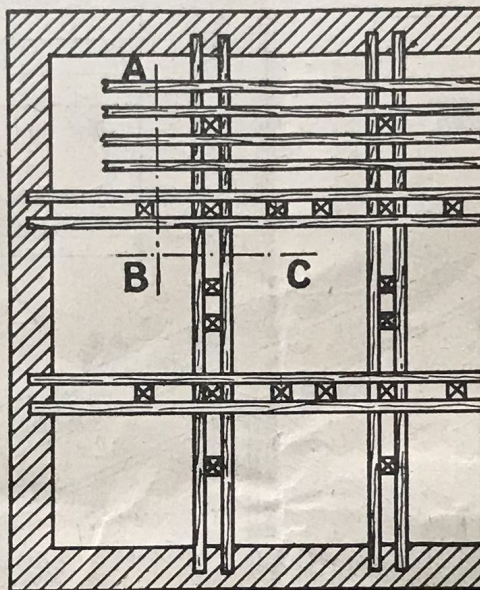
Vue en plan d'un plancher monté sur poteaux, avec la disposition relative des différents éléments. Les carrés sont les bouts des contre-fiches.
